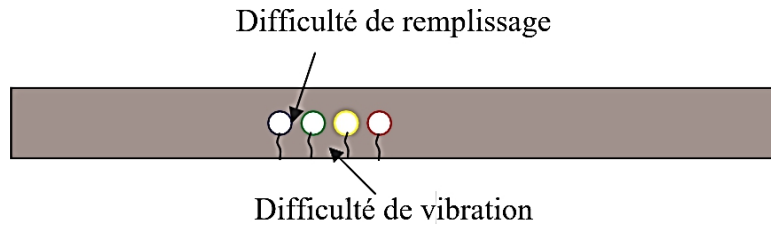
Fissuration liée à l'épaisseur du béton
